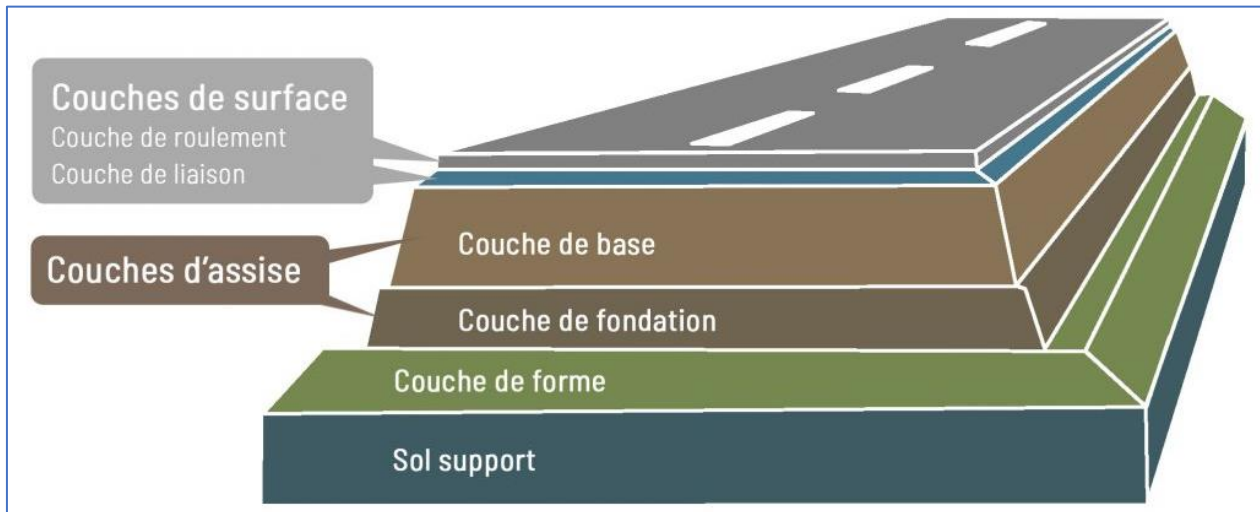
Structure de chaussée (Source : [structure de chaussée - Bing](#))
